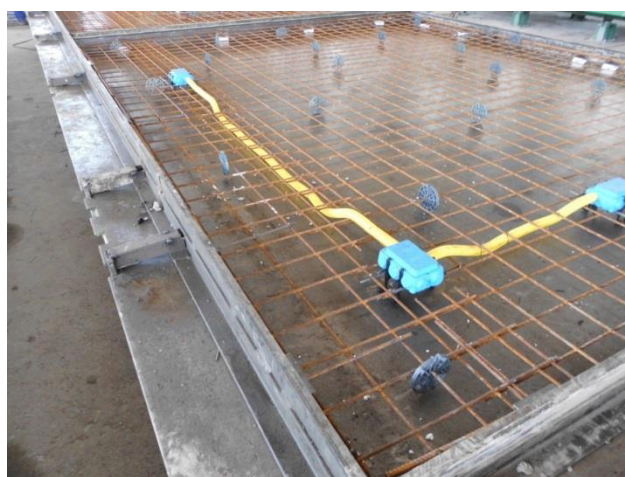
Armadura montada juntamente com eletrodutos e caixas de elétrica
